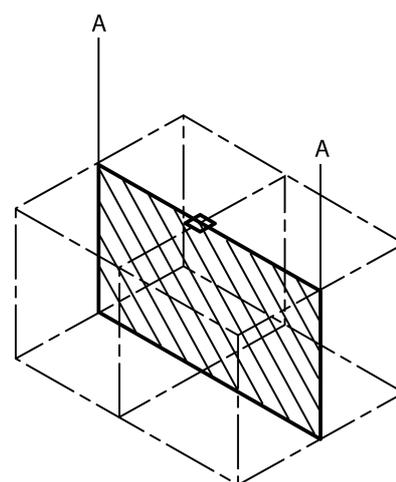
Diffuseur plafonnier – Exemple de plans d'essai
